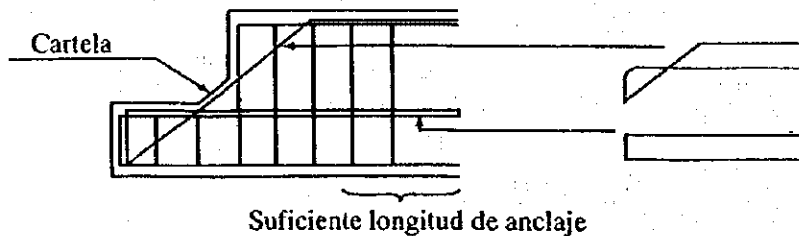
Anclaje de las armaduras en el extremo de la viga Gerber.
